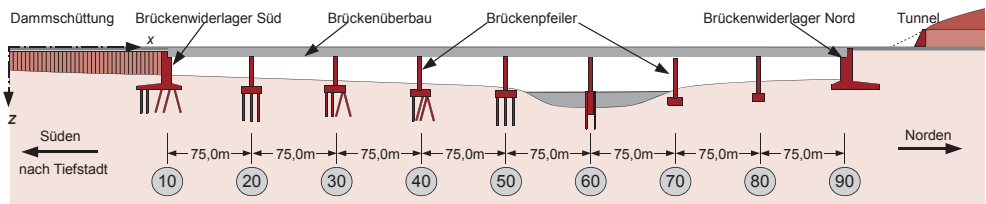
Beispiel Bahntrasse Damm-Brücke-Tunnel, Bauwerke und Stationierung
